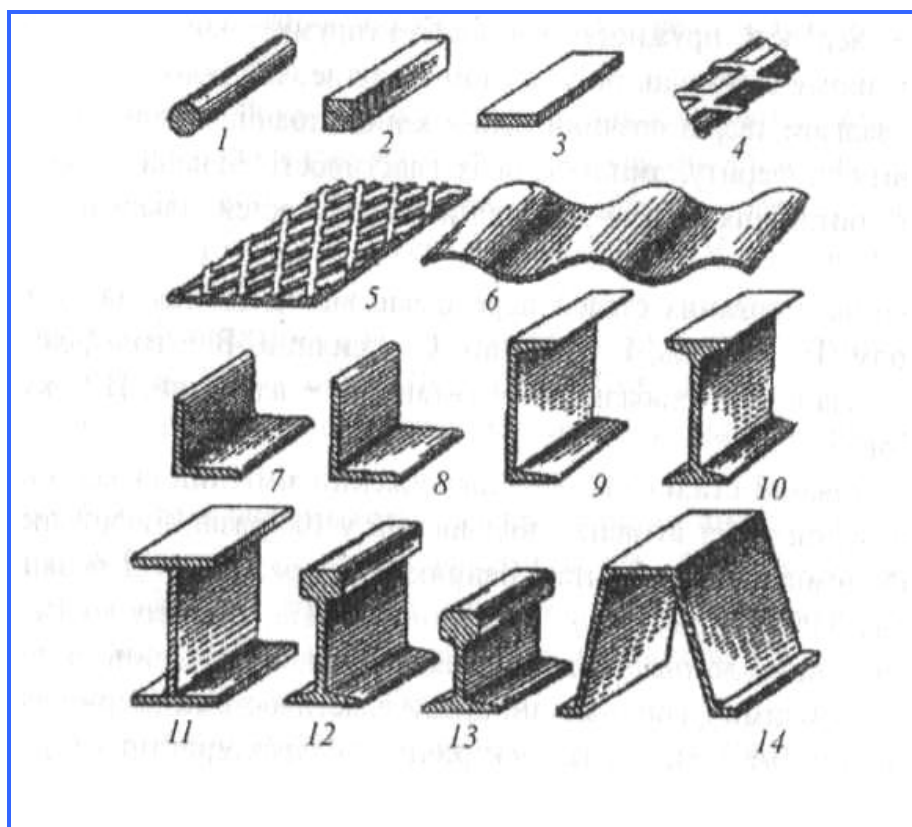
Прокатні вироби із сталі різного профілю: 1 – кругла; 2 – квадратна; 3 – штабова; 4 – періодичного профілю; 5 – рифлена; 6 – хвильова; 7 – кутикова рівнобока; 8 – кутикова нерівнобока; 9 – швелер; 10 – двотавр; 11 – двотавр зварний; 12 – рейки кранові; 13 – рейки залізничні; 14 – шпунтова паля.
